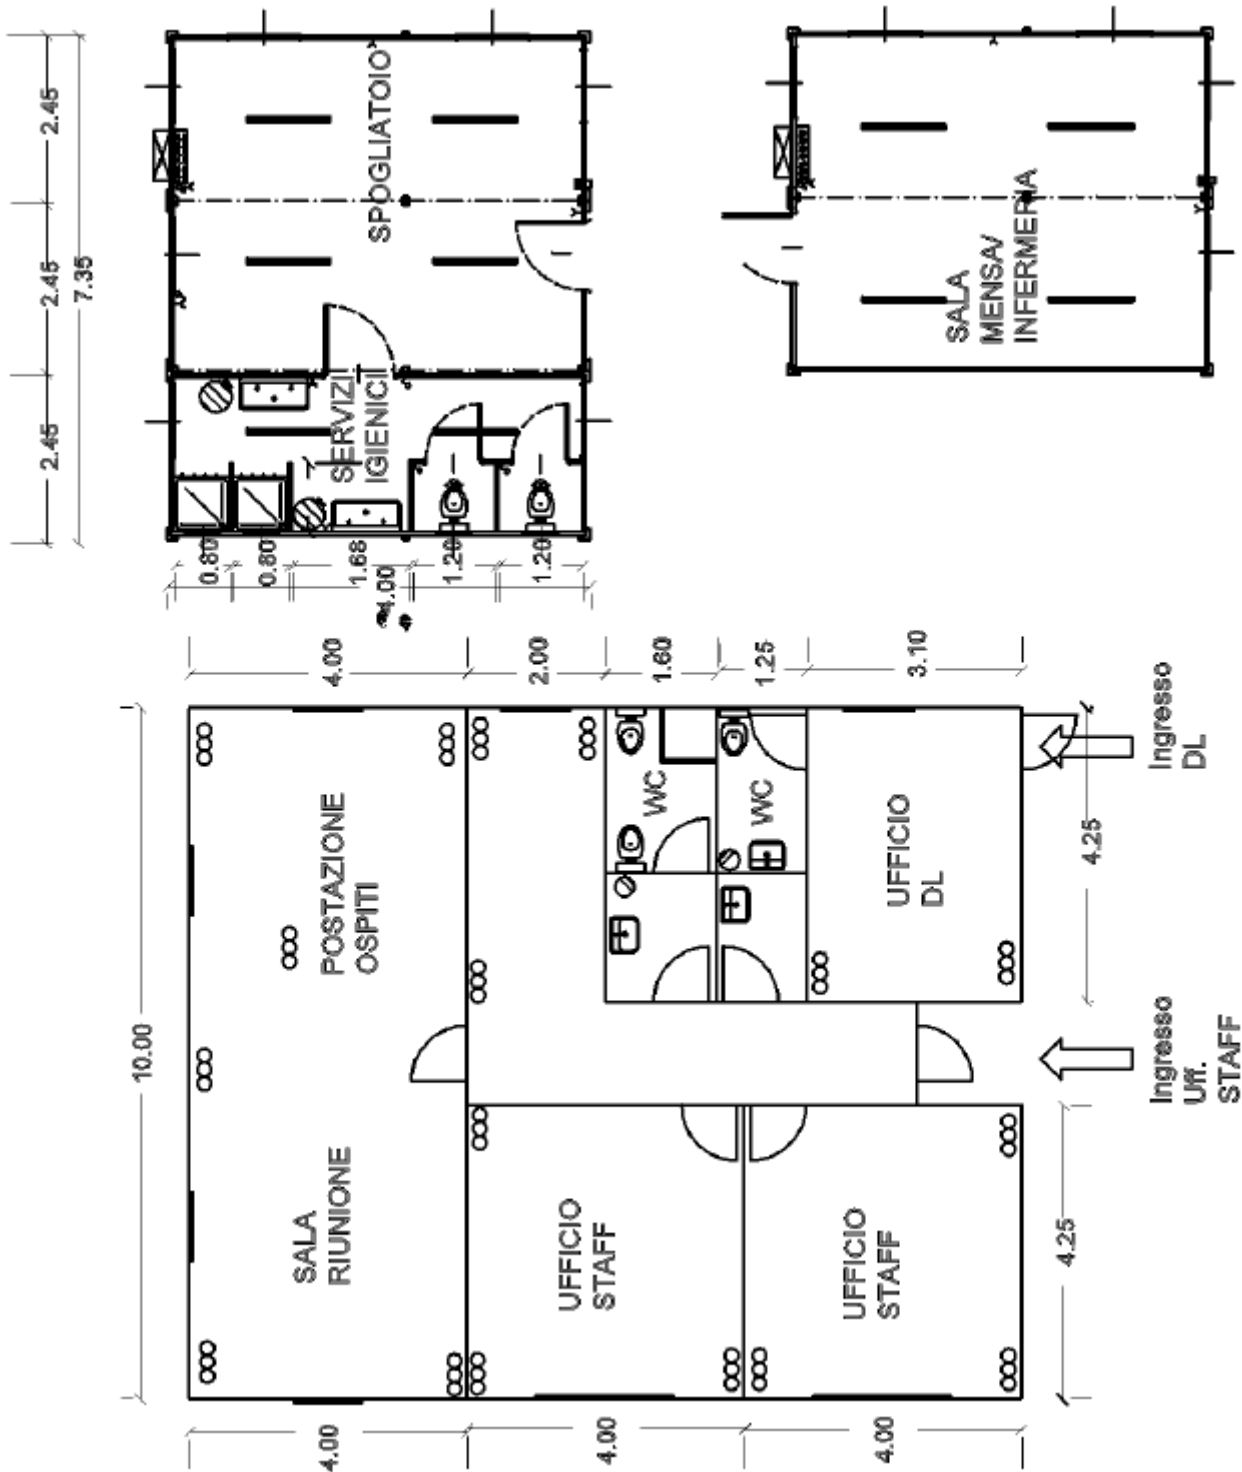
Baraccamenti ubicati nell'area logistica di cantiere
